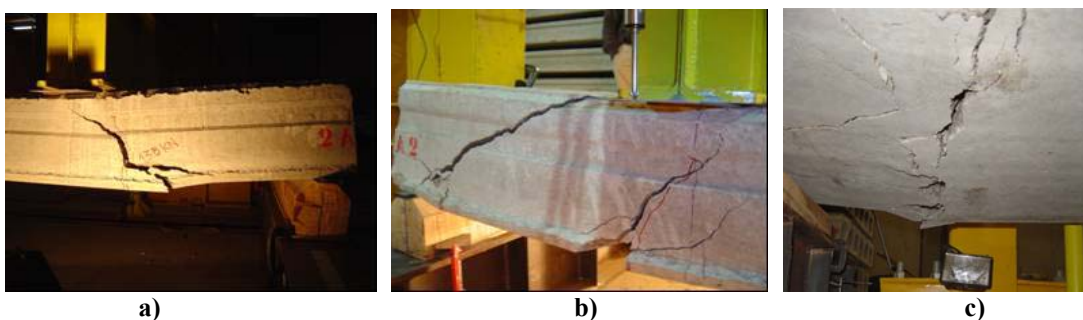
Abertura de fissura da laje L02-20-SC-6_C: a) Vista lateral - lado esquerdo; b) Vista lateral - lado direito; c) Parte inferior da laje.
